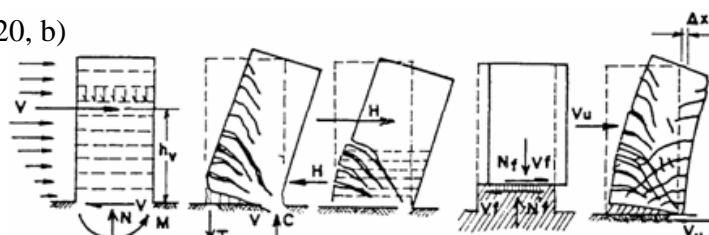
, a: Modos de falla en un muro de cortante en voladizo, de concreto reforzado cargado lateralmente
